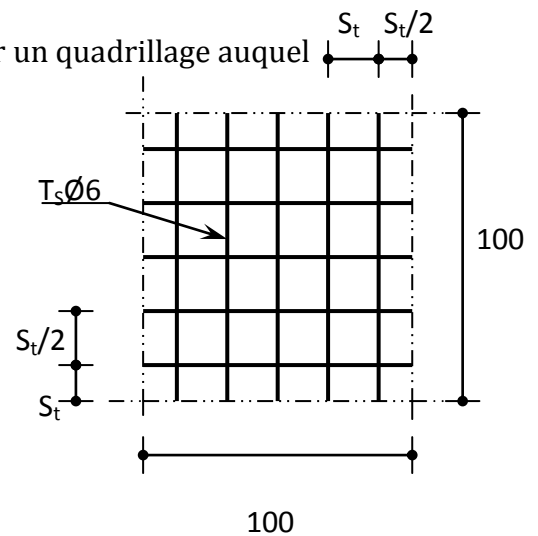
Disposition constructive des armatures de la dalle de compression
